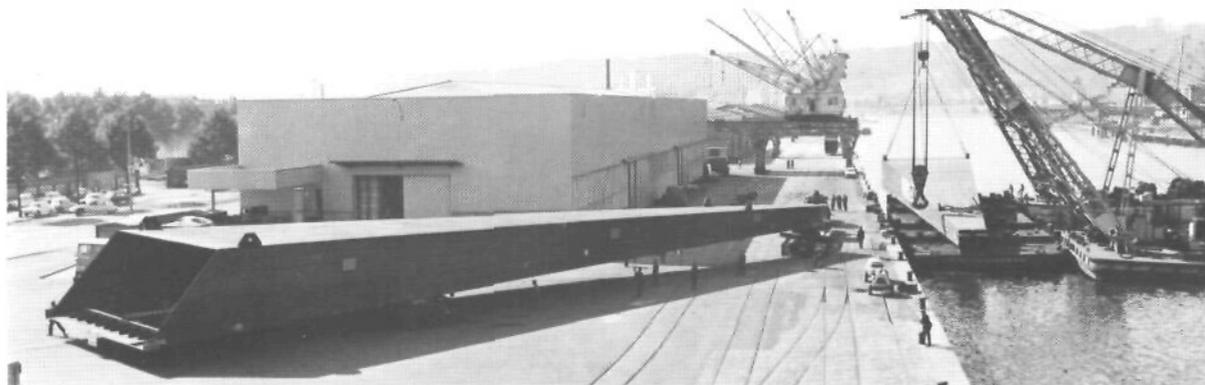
Embarquement des béquilles sur les pontons utilisés pour le transport, à l'aide de deux bigues.
